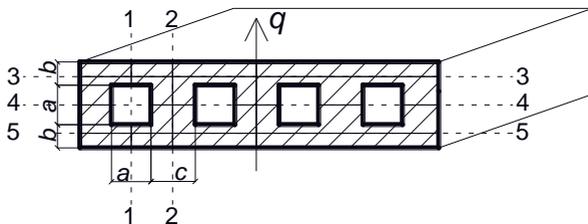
Расчетная модель плиты чердачного перекрытия
